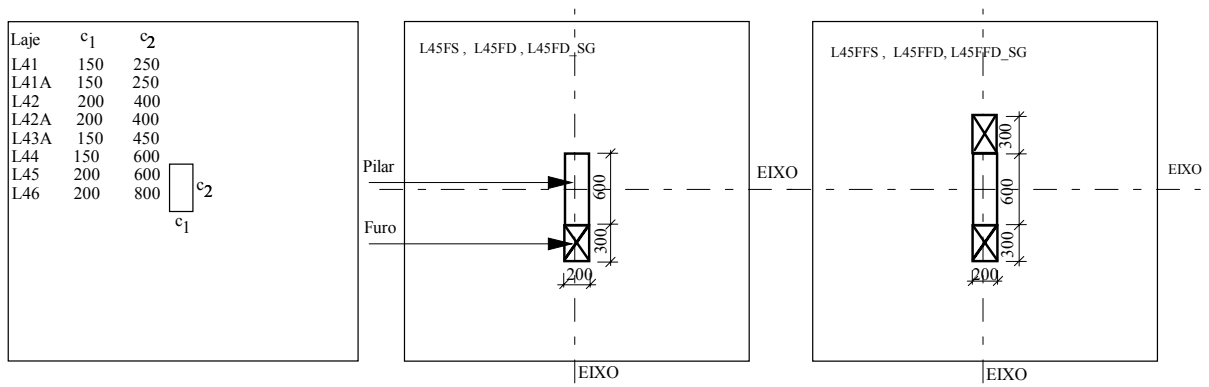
Lajes com pilares retangulares e lajes com furos
